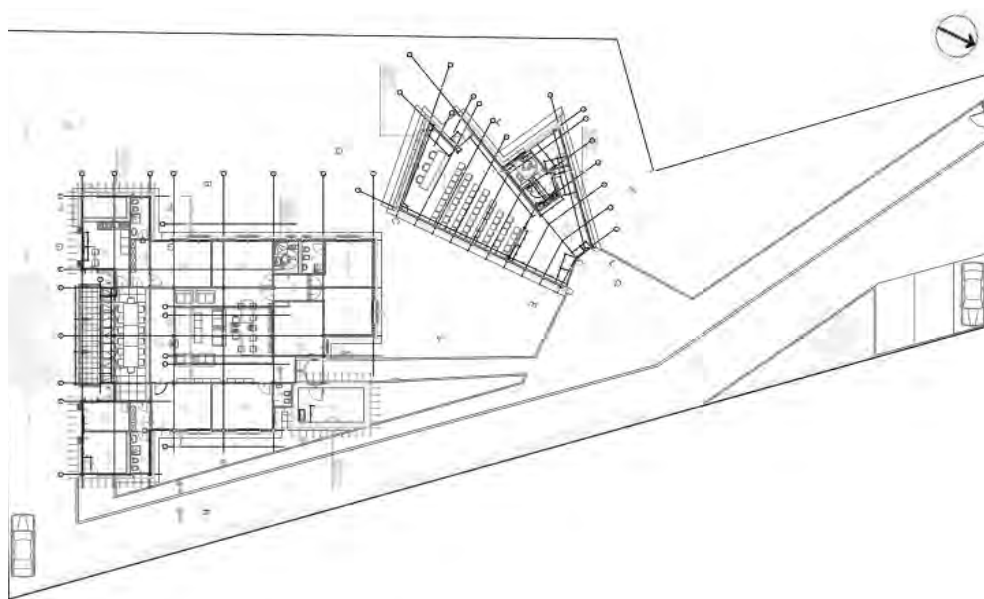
Pianta dell'edificio 'Casa famiglia per minori' a Lodi (Fonte: documentazione progettuale fornita dallo studio di progettazione AIACE. Arch. Ettore Zambelli)
